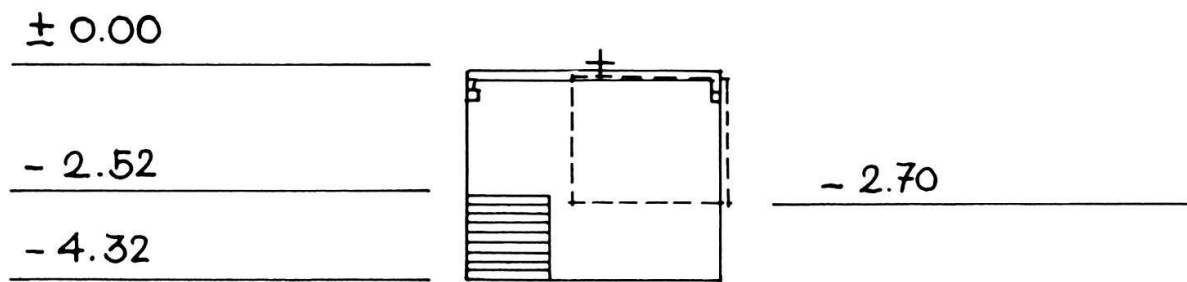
Keller Kramgasse 17: Aufrissplan Mst. 1 : 200, Grundriss und Schnitt, 26. August 1978.
